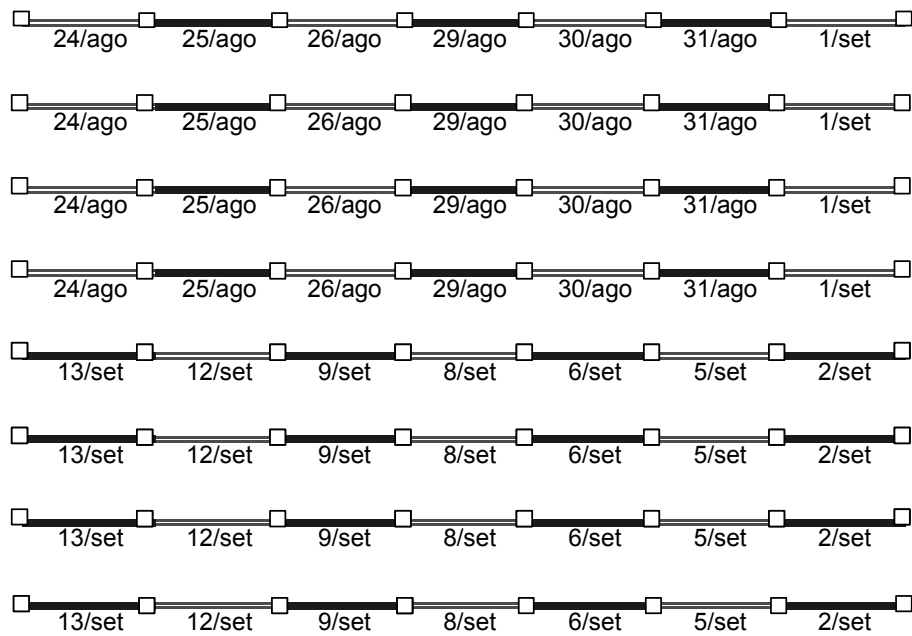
Plano de seqüenciamento da montagem das vigas – Etapa 1
